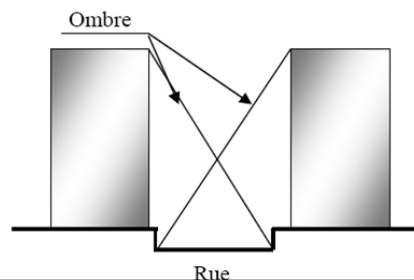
Proportions respectées entre les hauteurs du bâti et la largeur de la voirie (La largeur de front de rue variant entre 15 et 20 m.)
